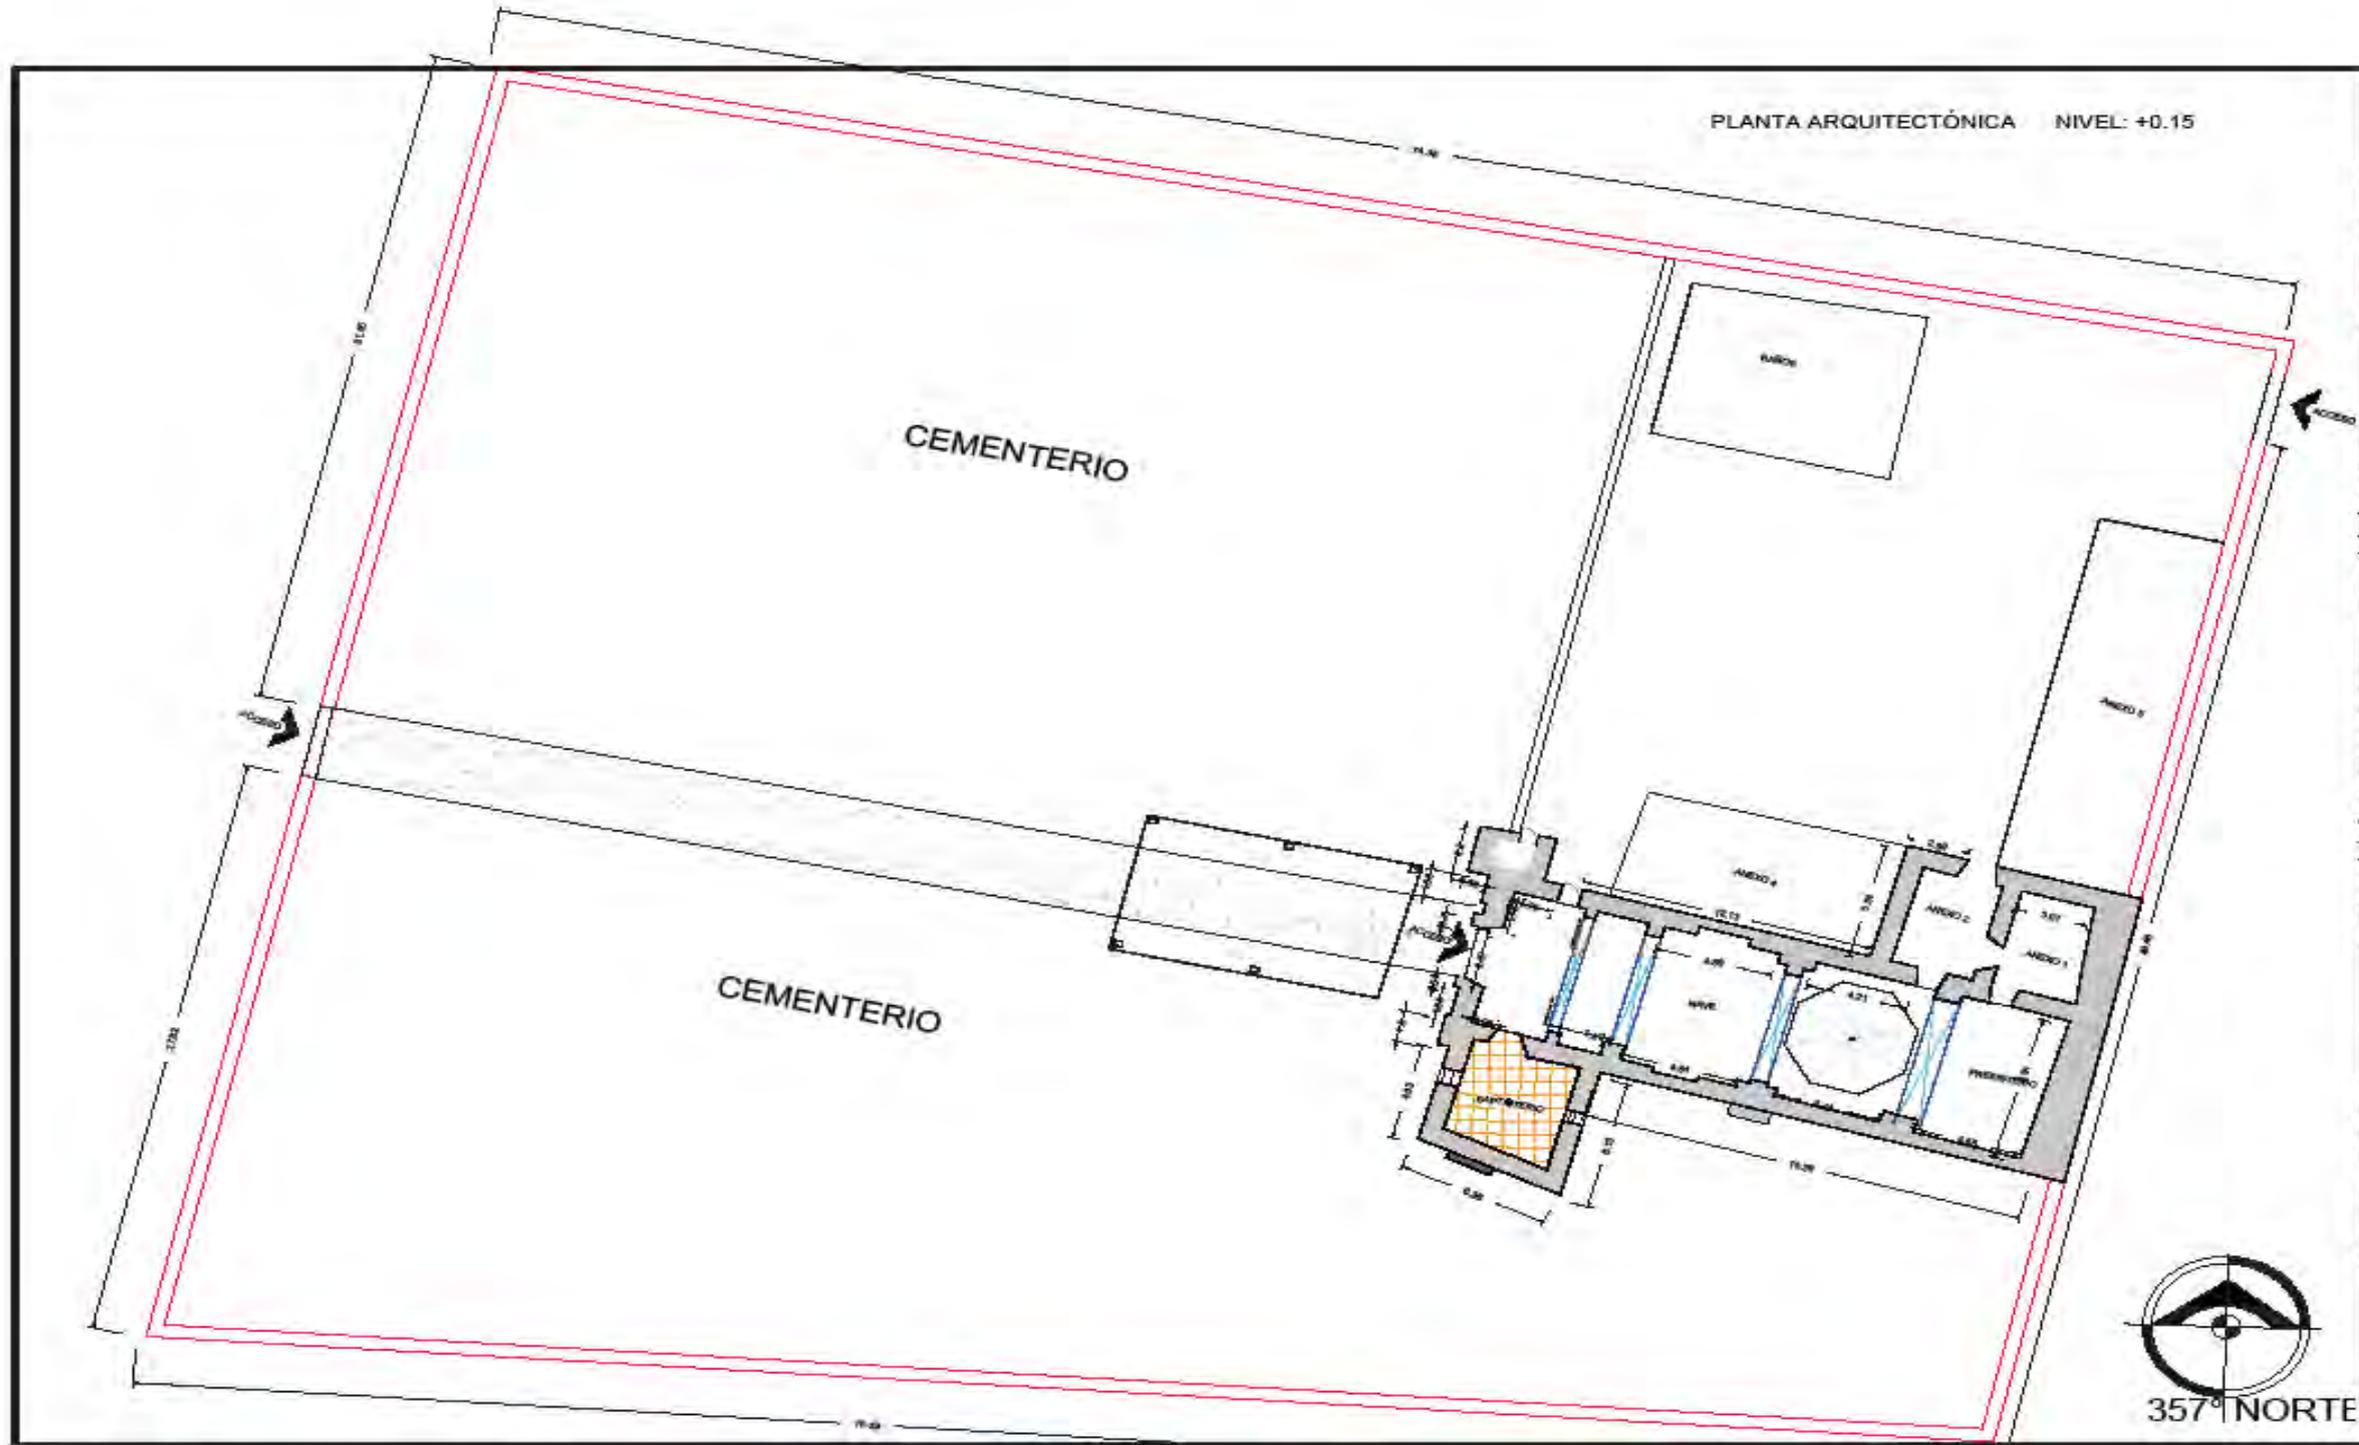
Detalles arquitectónicos.* Elaboración propia. (2018)
